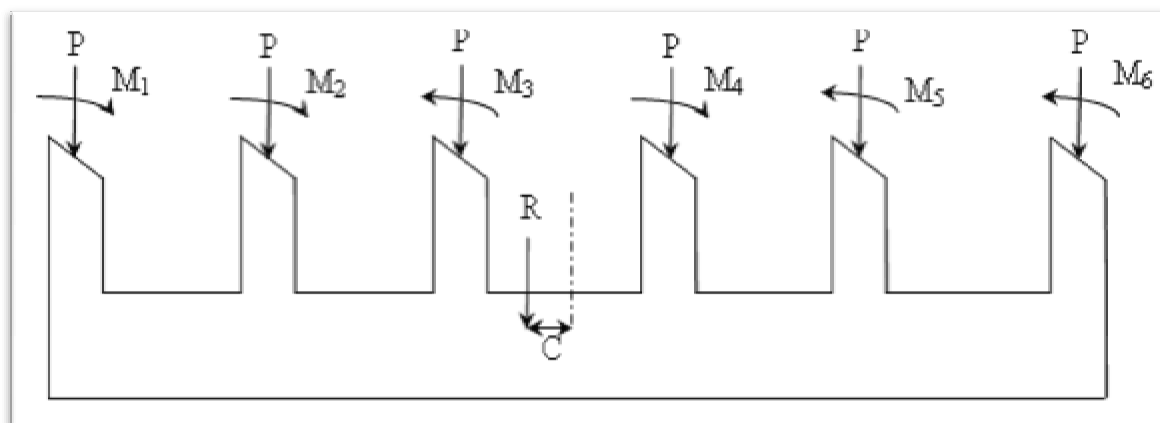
Coupe verticale de la semelle filante sous poteaux.
